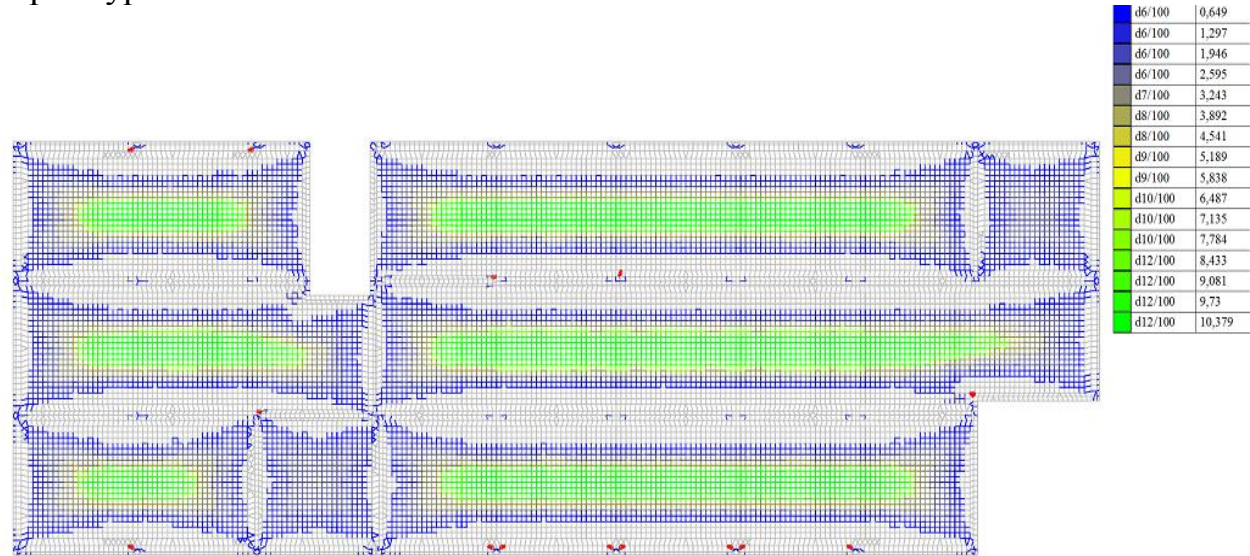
Схема нижнего армирования плиты по оси у
